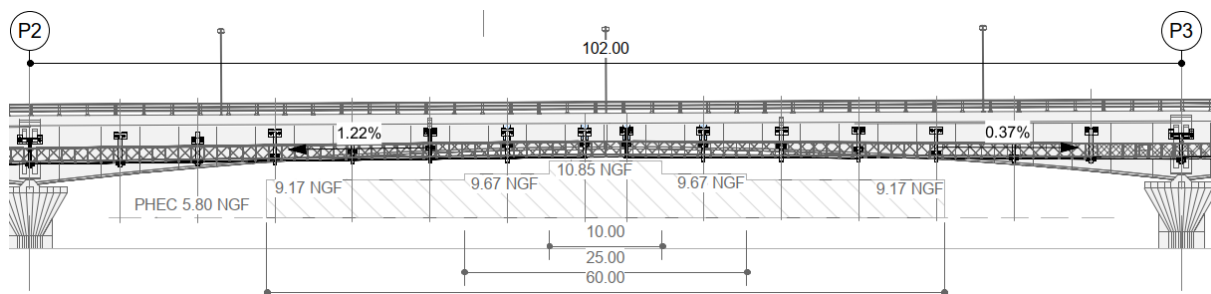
Consoles accrochées latéralement au pont sur une travée courante (T2 à T6) - Extrait du cahier de plans PRO
